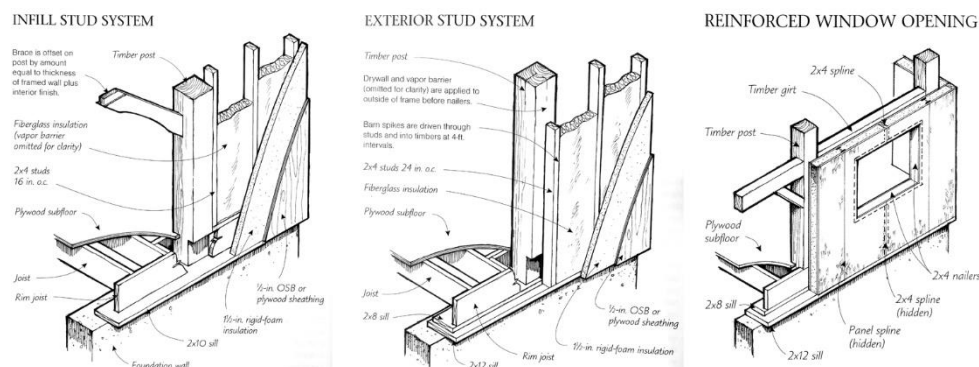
Tipos de revestimento com o sistema de porticados: 1) painéis de reticulados leves entre a estrutura; 2) pelo exterior da estrutura e 3) painéis SIP pelo exterior da estrutura com um vão (Benson, 1977).
